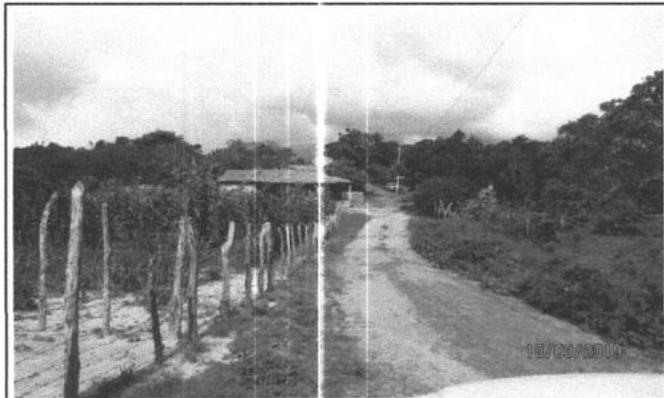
S.D.O. 07 (trecho 2) - bueiro
